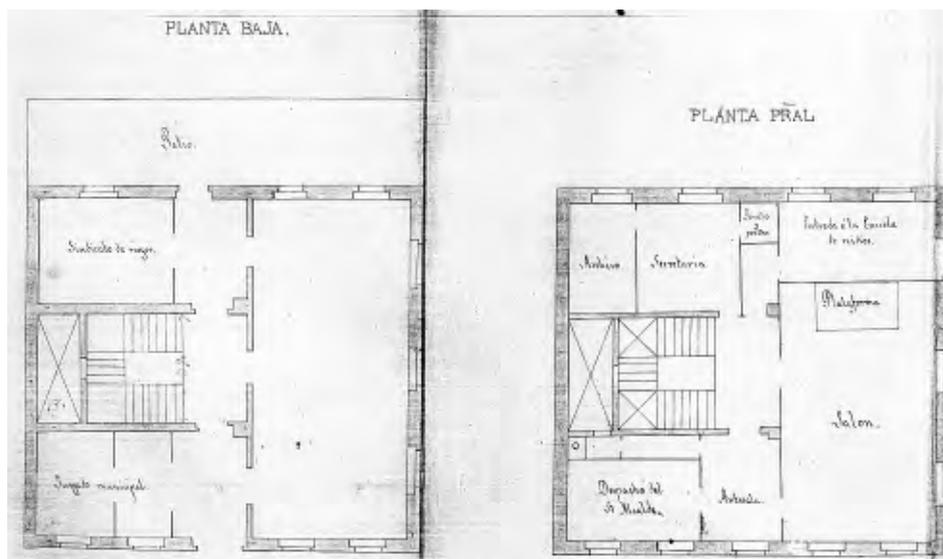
Plantas baja y principal del edificio para Casa Consistorial y escuelas de Cetina, por el arquitecto Félix Navarro, mayo de 1882 (Archivo de la Diputación Provincial de Zaragoza).
